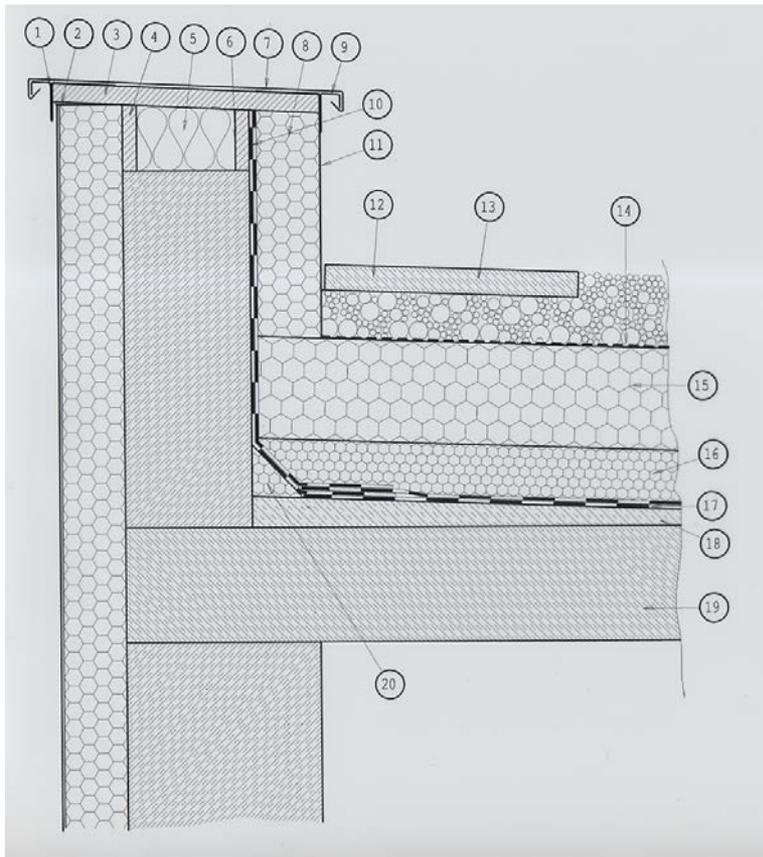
Aufbau Umkehrdach (Gründach Intensiv)
